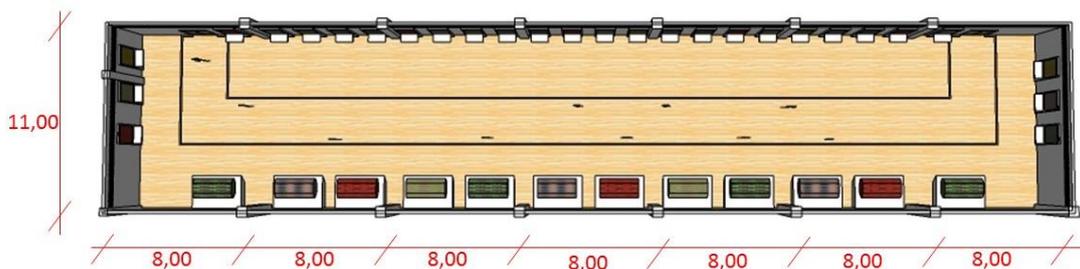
Potongan Orthogonal Atas Ruang Pamer S
